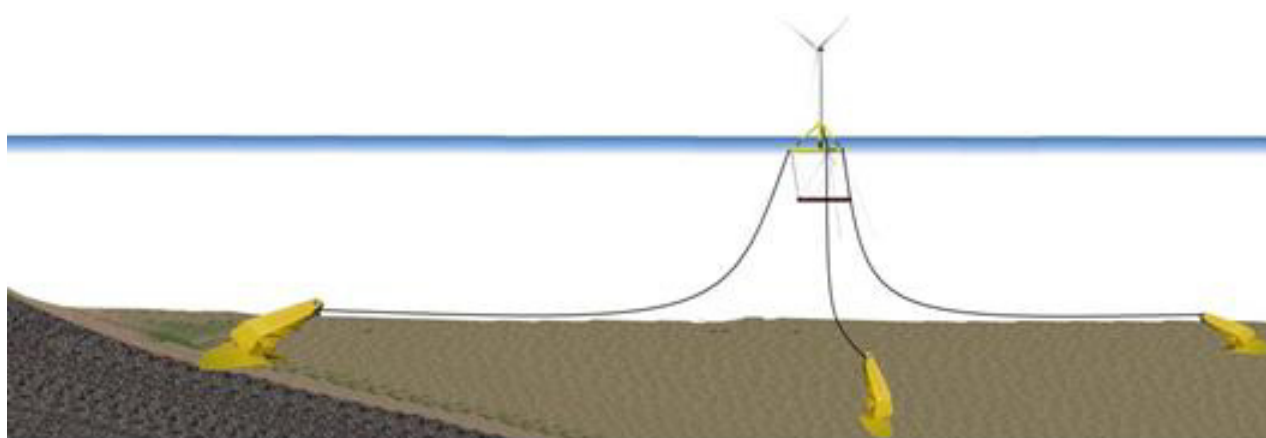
Particolare della fondazione galleggiante di tipo floating ad ancoraggio con catenaria
